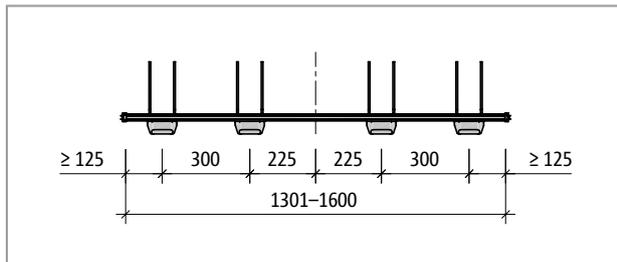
Schöck Tronsole® Typ T-V4-...-L1301 bis L1600: Produktgrundriss
